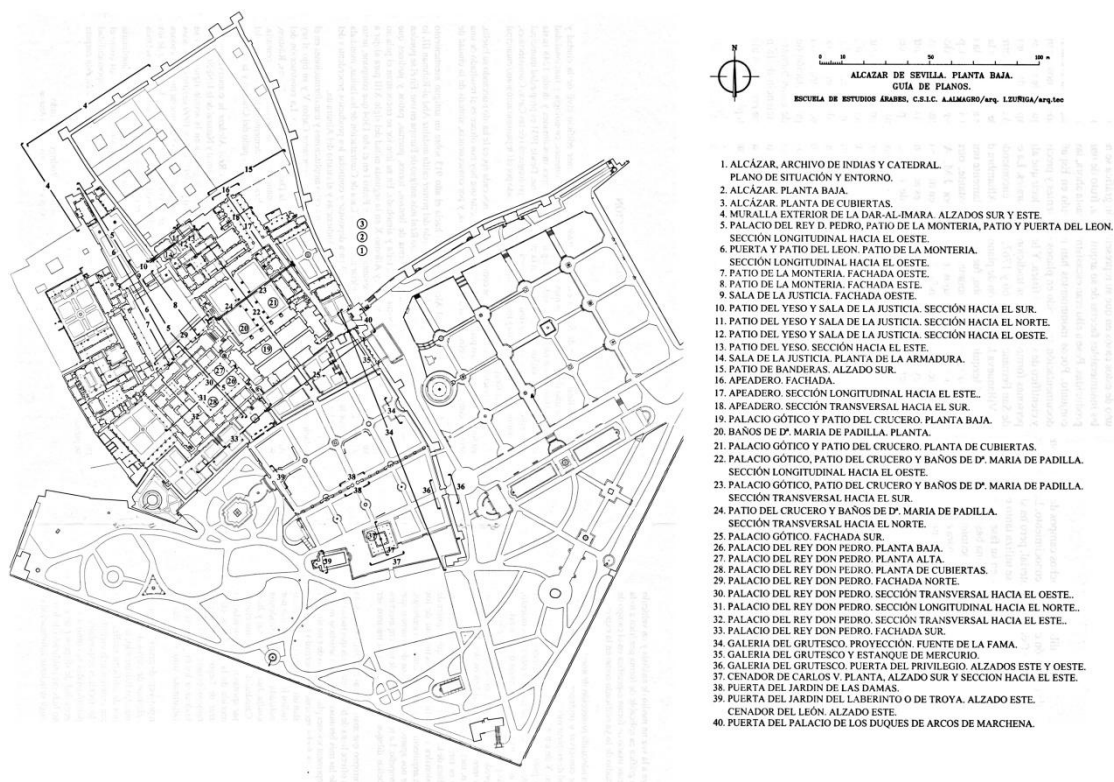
Reconstrucción de la planta del Alcázar de Sevilla, Tomado de EEA (2000, 2).
